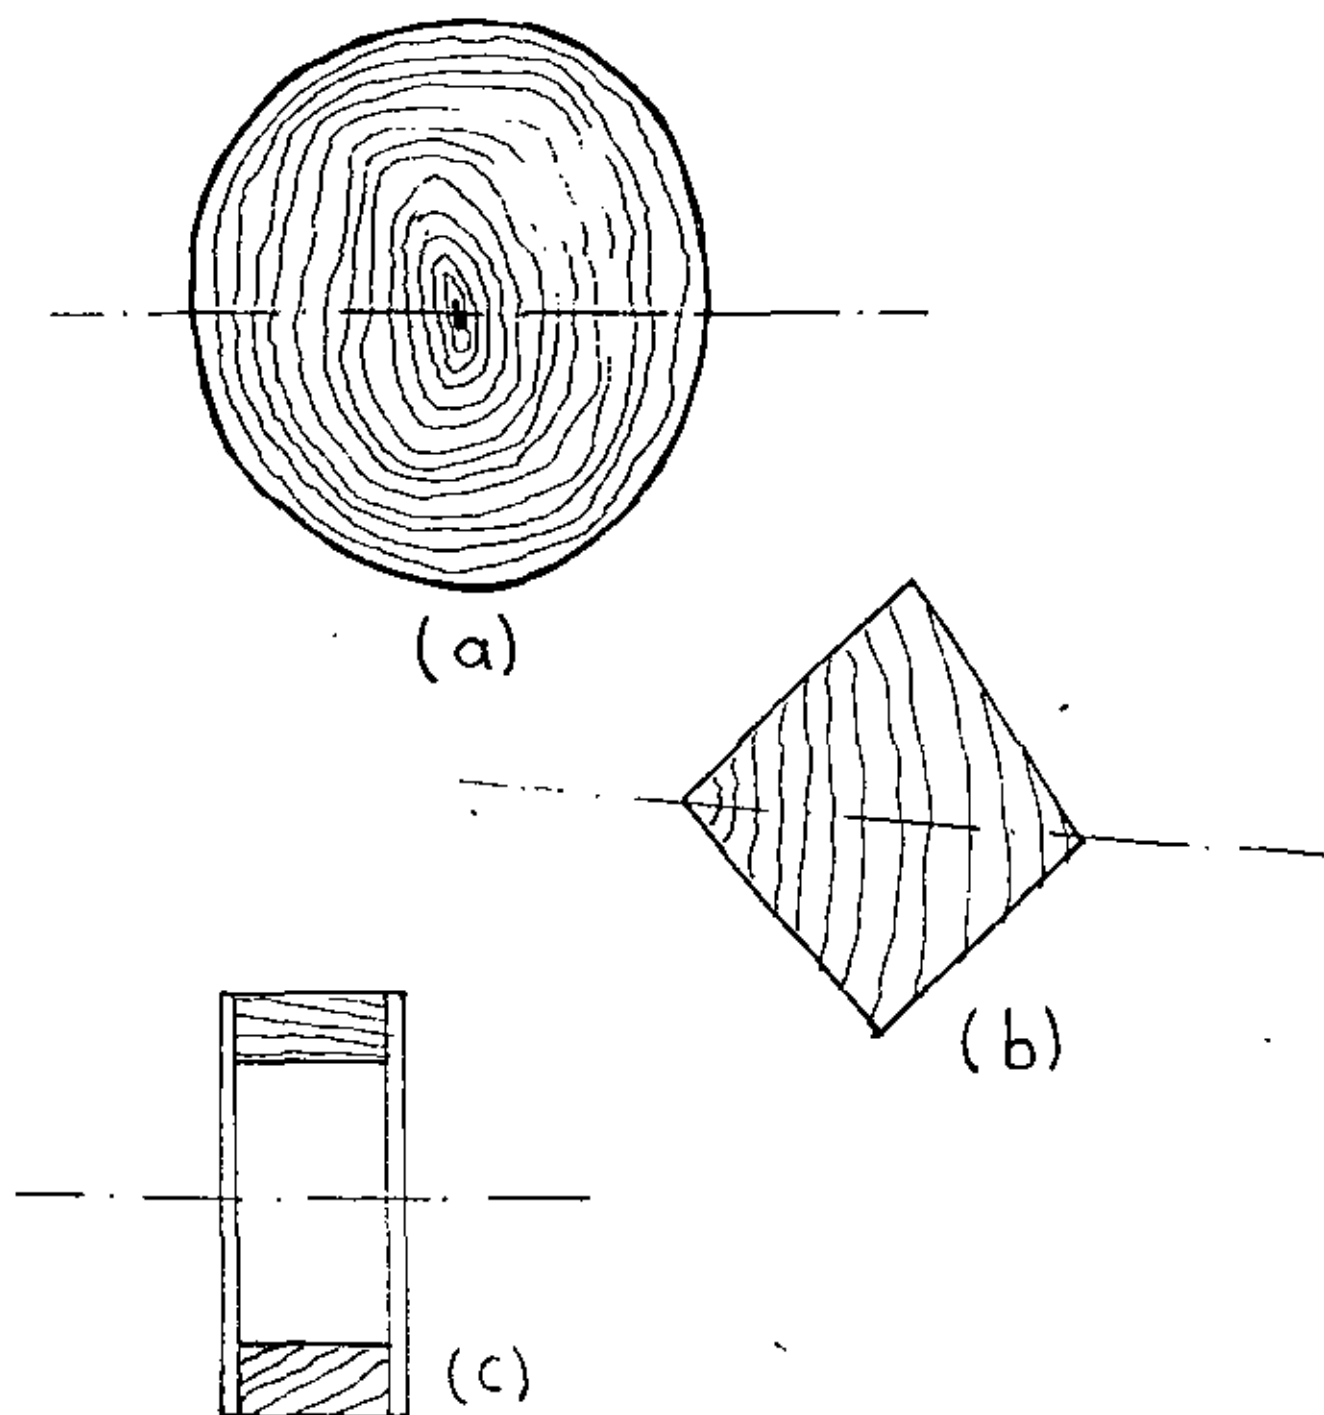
SECCIONES DE VIGAS DE MADERA.
